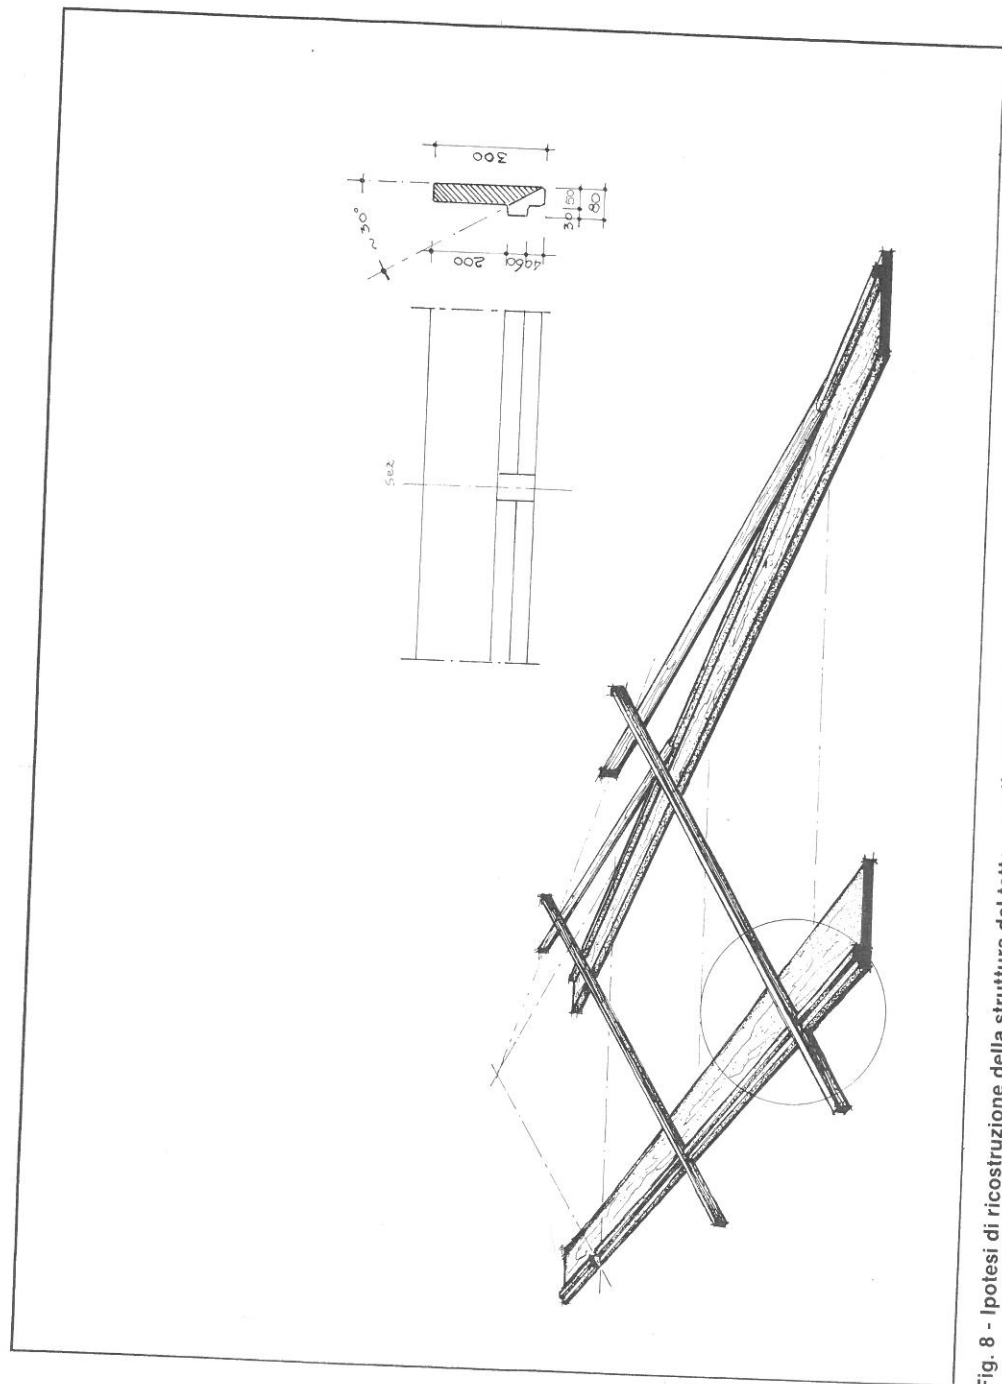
Ipotesi di ricostruzione della struttura del tetto e particolare/sezione del trave di falda. (Dis. Pico Spinelli).
